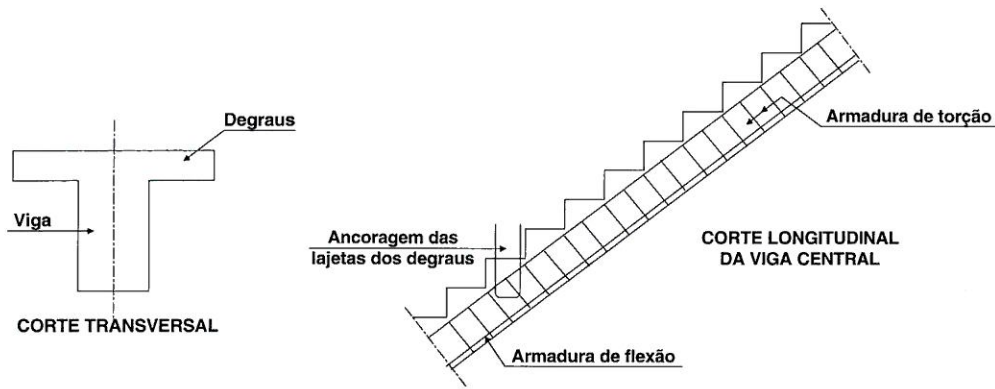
Disposição das armaduras da escada com longarina central (Exemplo 2.4)
